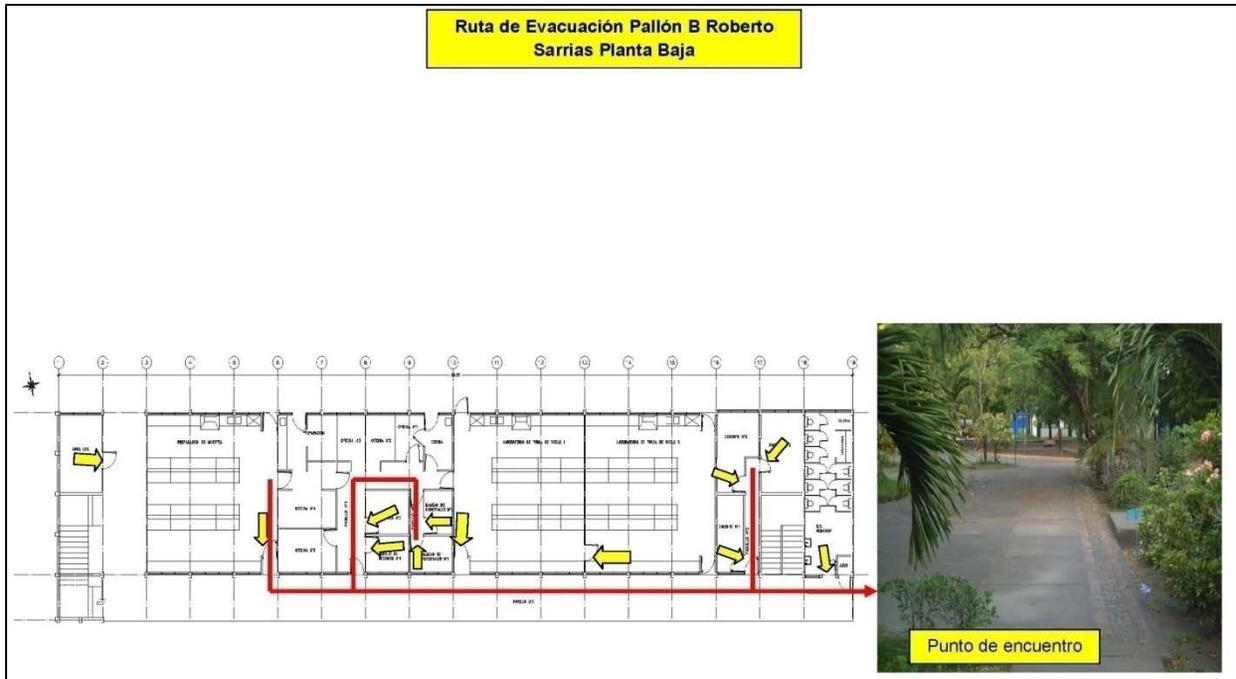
Ruta de evacuación del pabellón “B” (planta baja)
